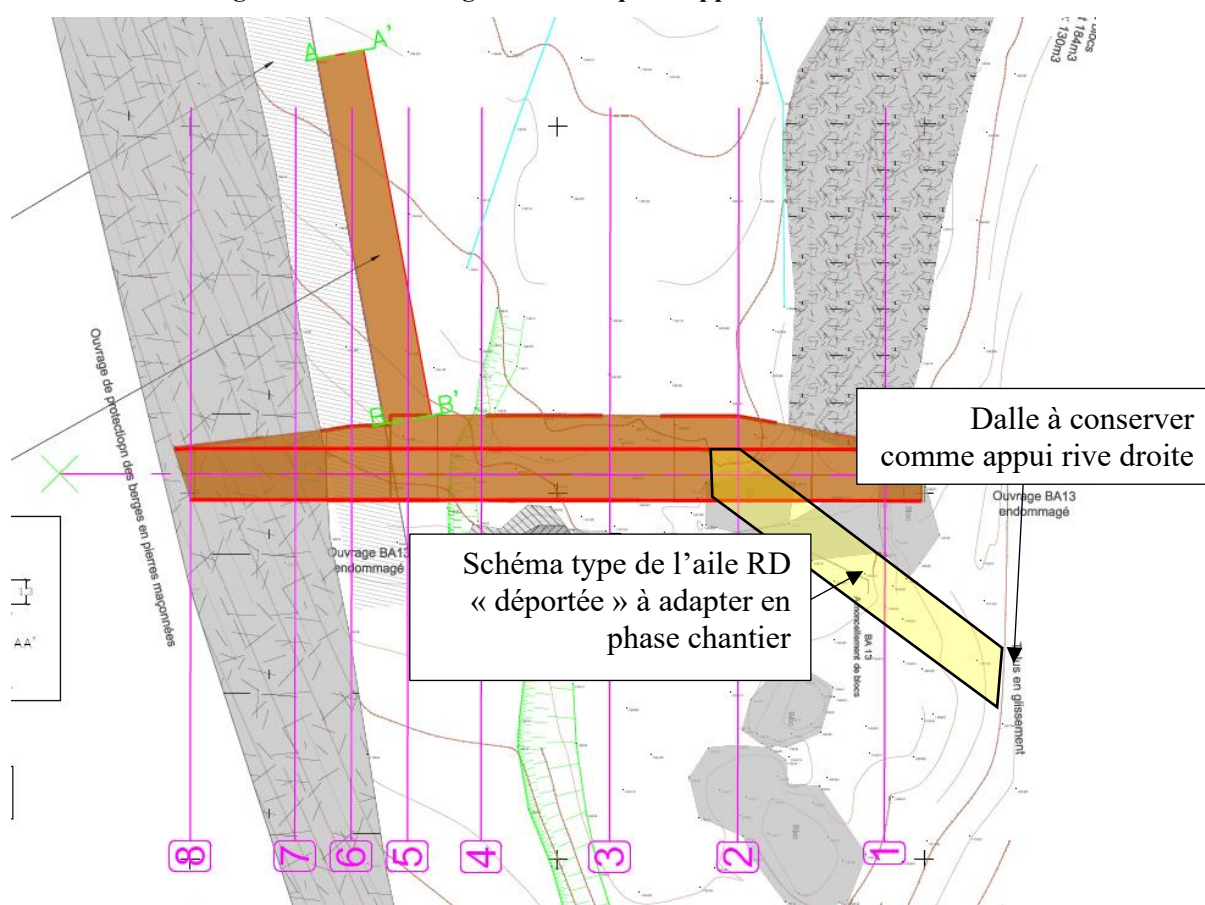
Plan masse du BA13 et dessin schématique indicatif de l'aile rive droite « déportée »
